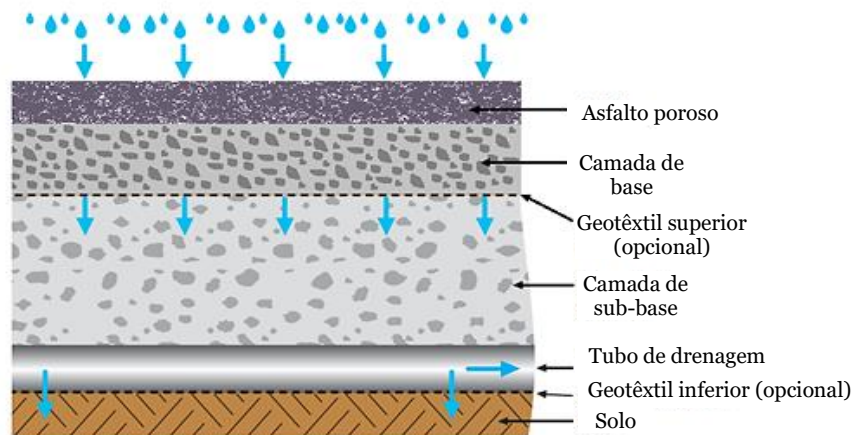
Perfil esquemático – infiltração parcial (Adaptado de Interpave, 2010)
